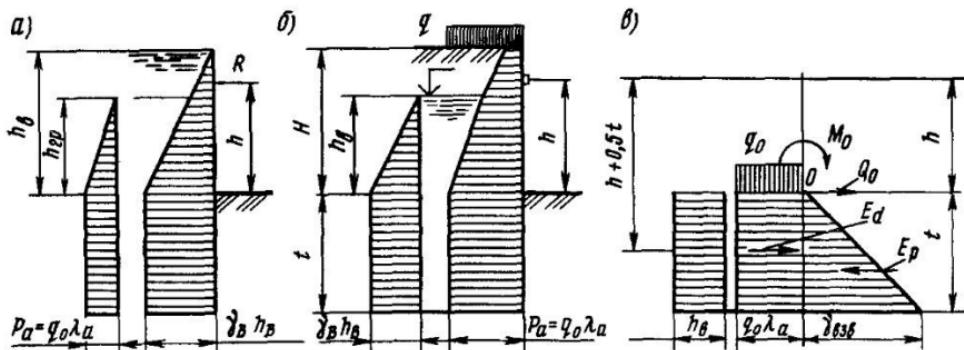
Схема для расчета стенки с одним ярусом креплений в несвязных грунтах:
